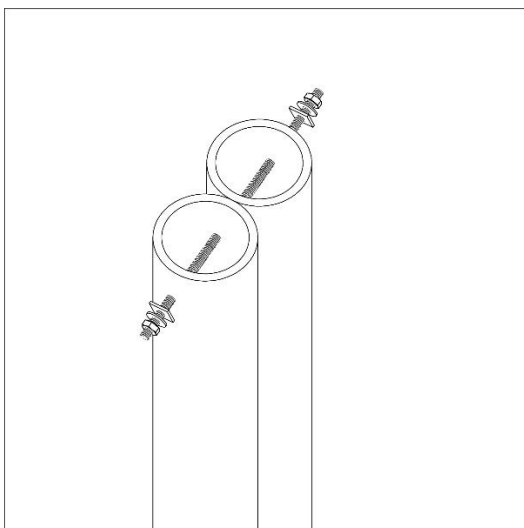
Schema connessione trasversale a taglio retto tipo CON 2.
